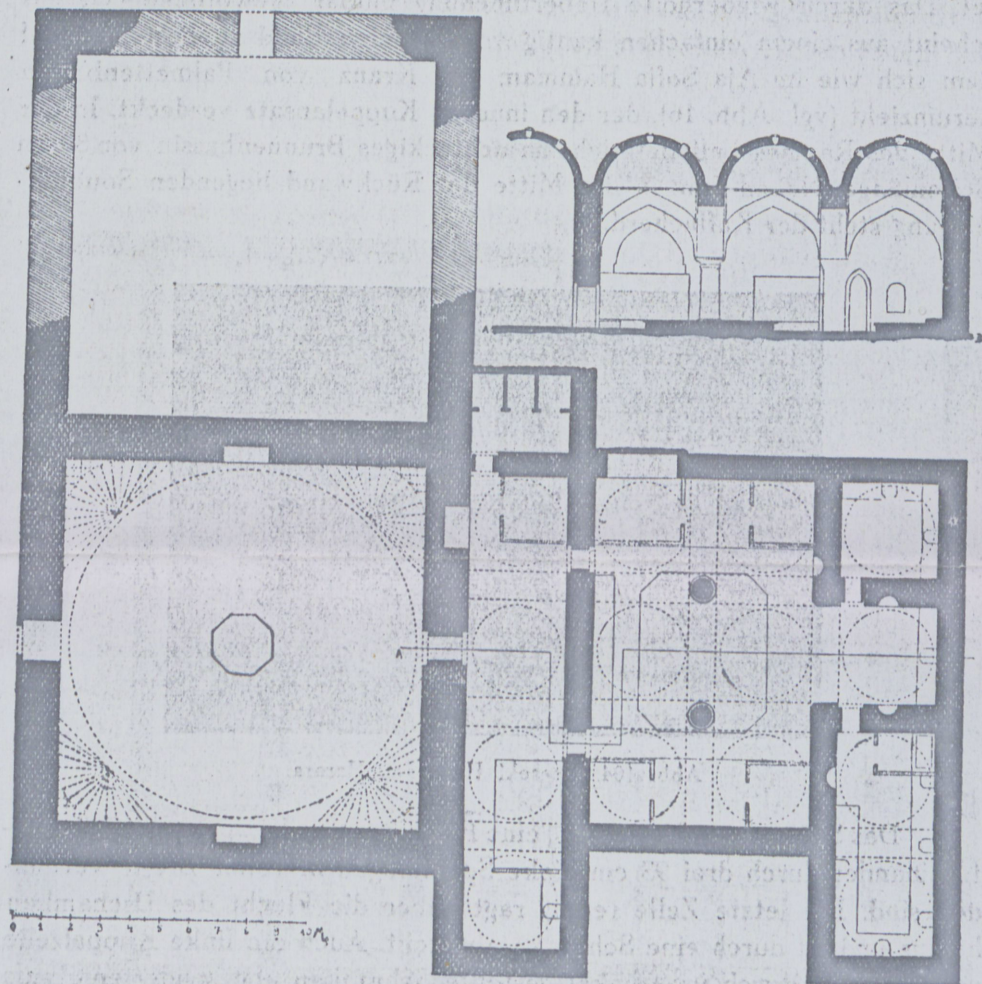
Hasseki Hammam, Grundriß und Schnitt.
